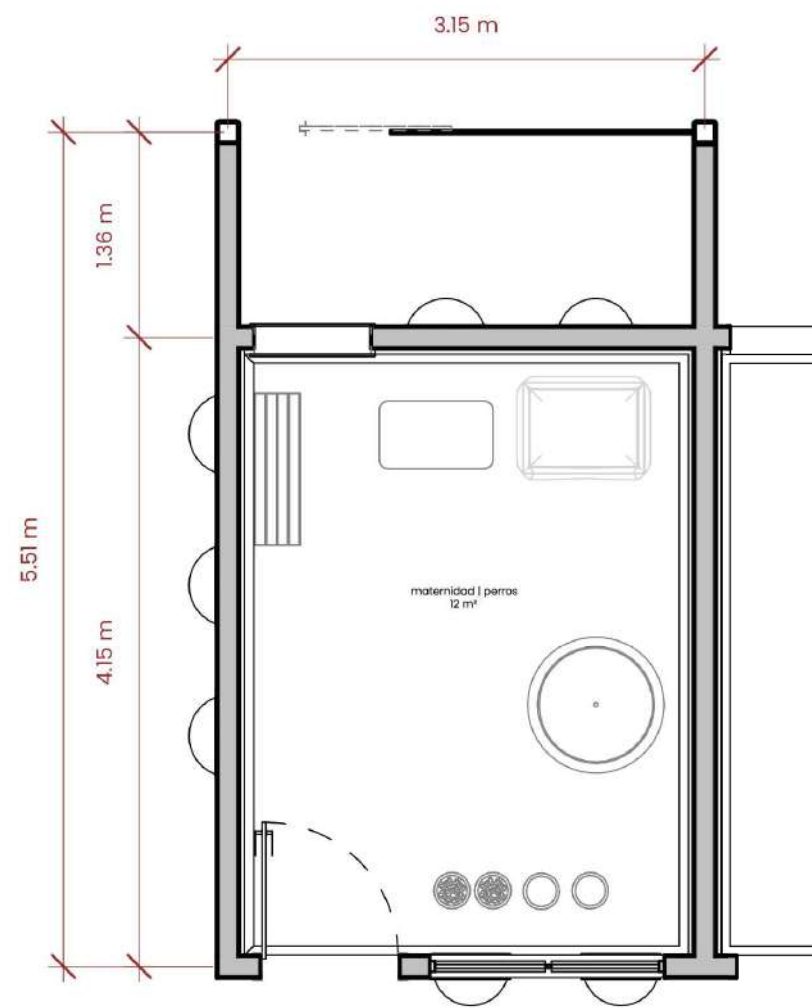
Detalle cuarto de perros en refugio. Fuente: Elaboración propia
